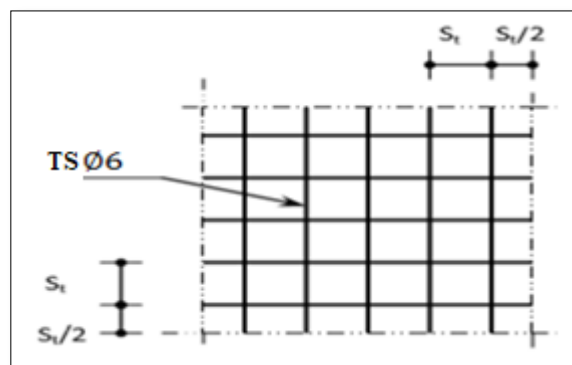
Disposition constructive des armatures de la dalle de compression
